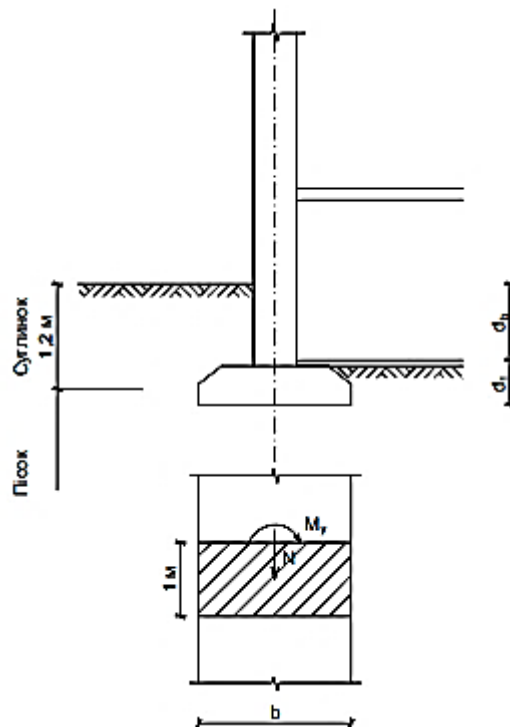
Схема розміщення стрічкового фундаменту у ґрунті
